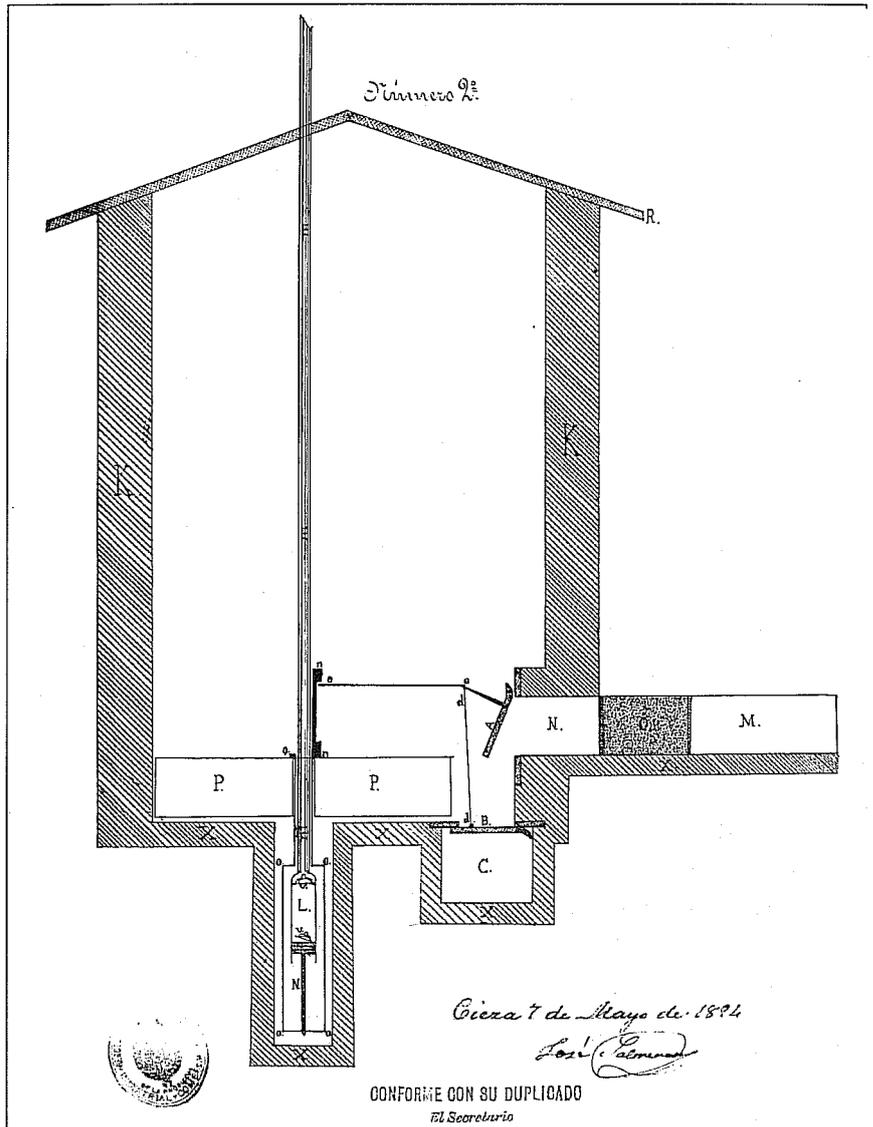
Alzado del Flotador Salmerón. Plano Número 2, original de la patente.
